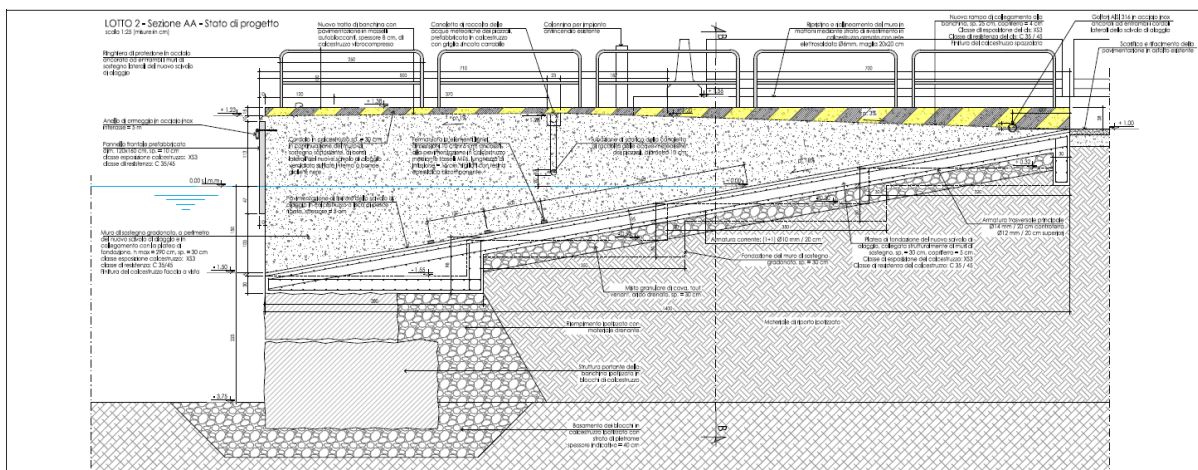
sezione longitudinale stralcia nuovo scivolo di alaggio
